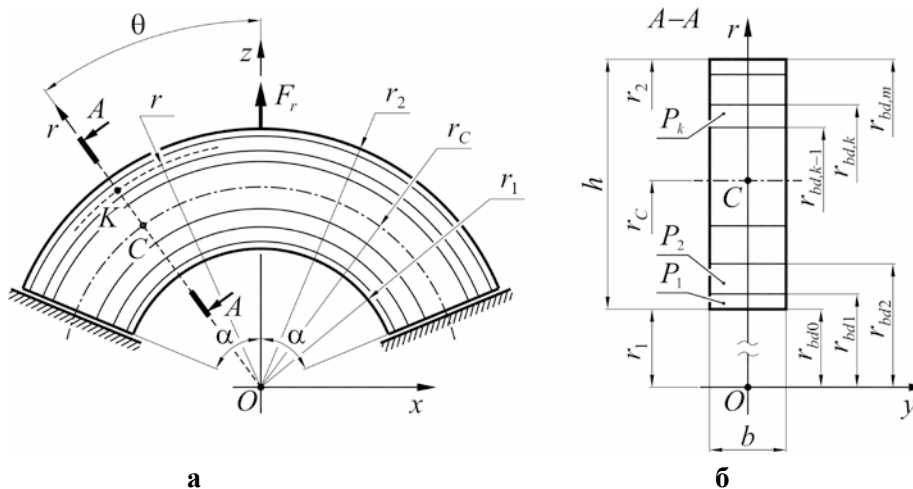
Схема багатошарової арки (а) і її поперечного перерізу (б)
